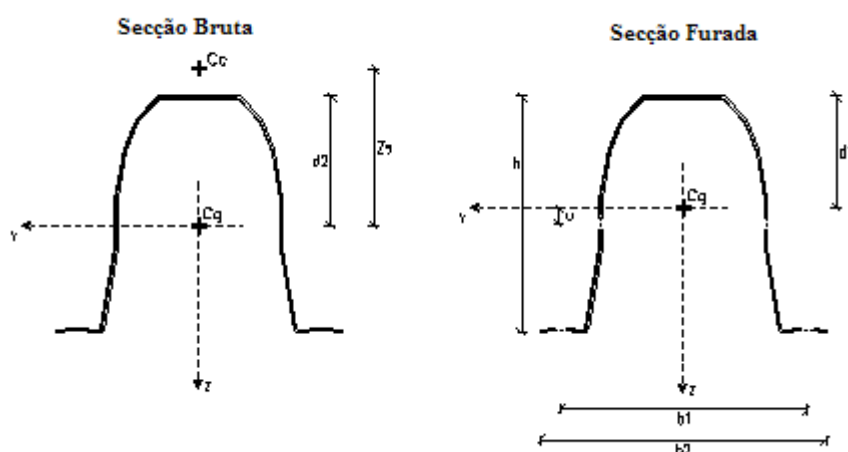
Secção bruta e secção efectiva do perfil MadreMax [1].
